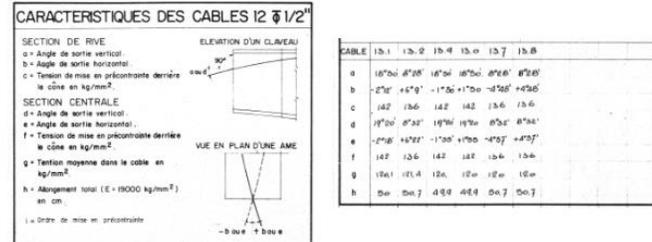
Caractéristiques des câbles de fléau 13 - Extrait du plan « 83 - 14.943 B - Superstructure des 3 travées centrales - Tête de claveau 8 et 13' - Coffrage, câblage et armatures »
